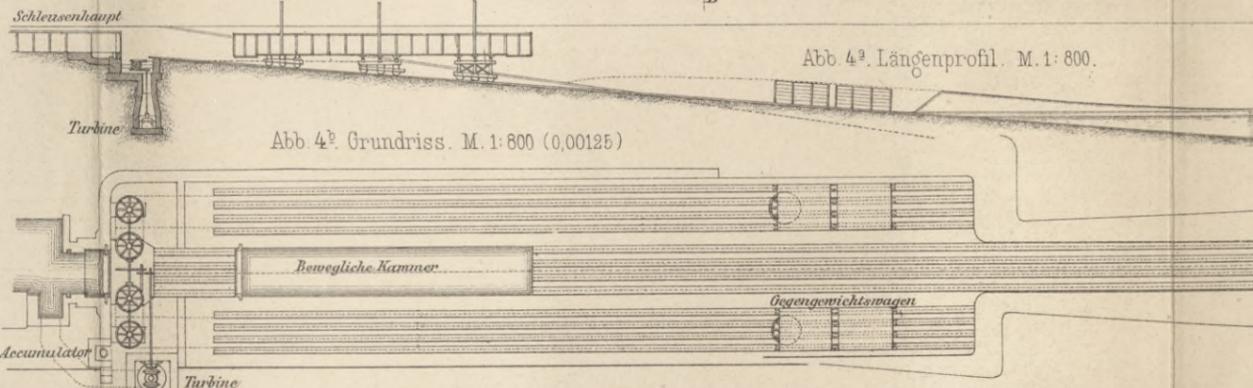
Grundriss. M. 1:800 (0,00125)
